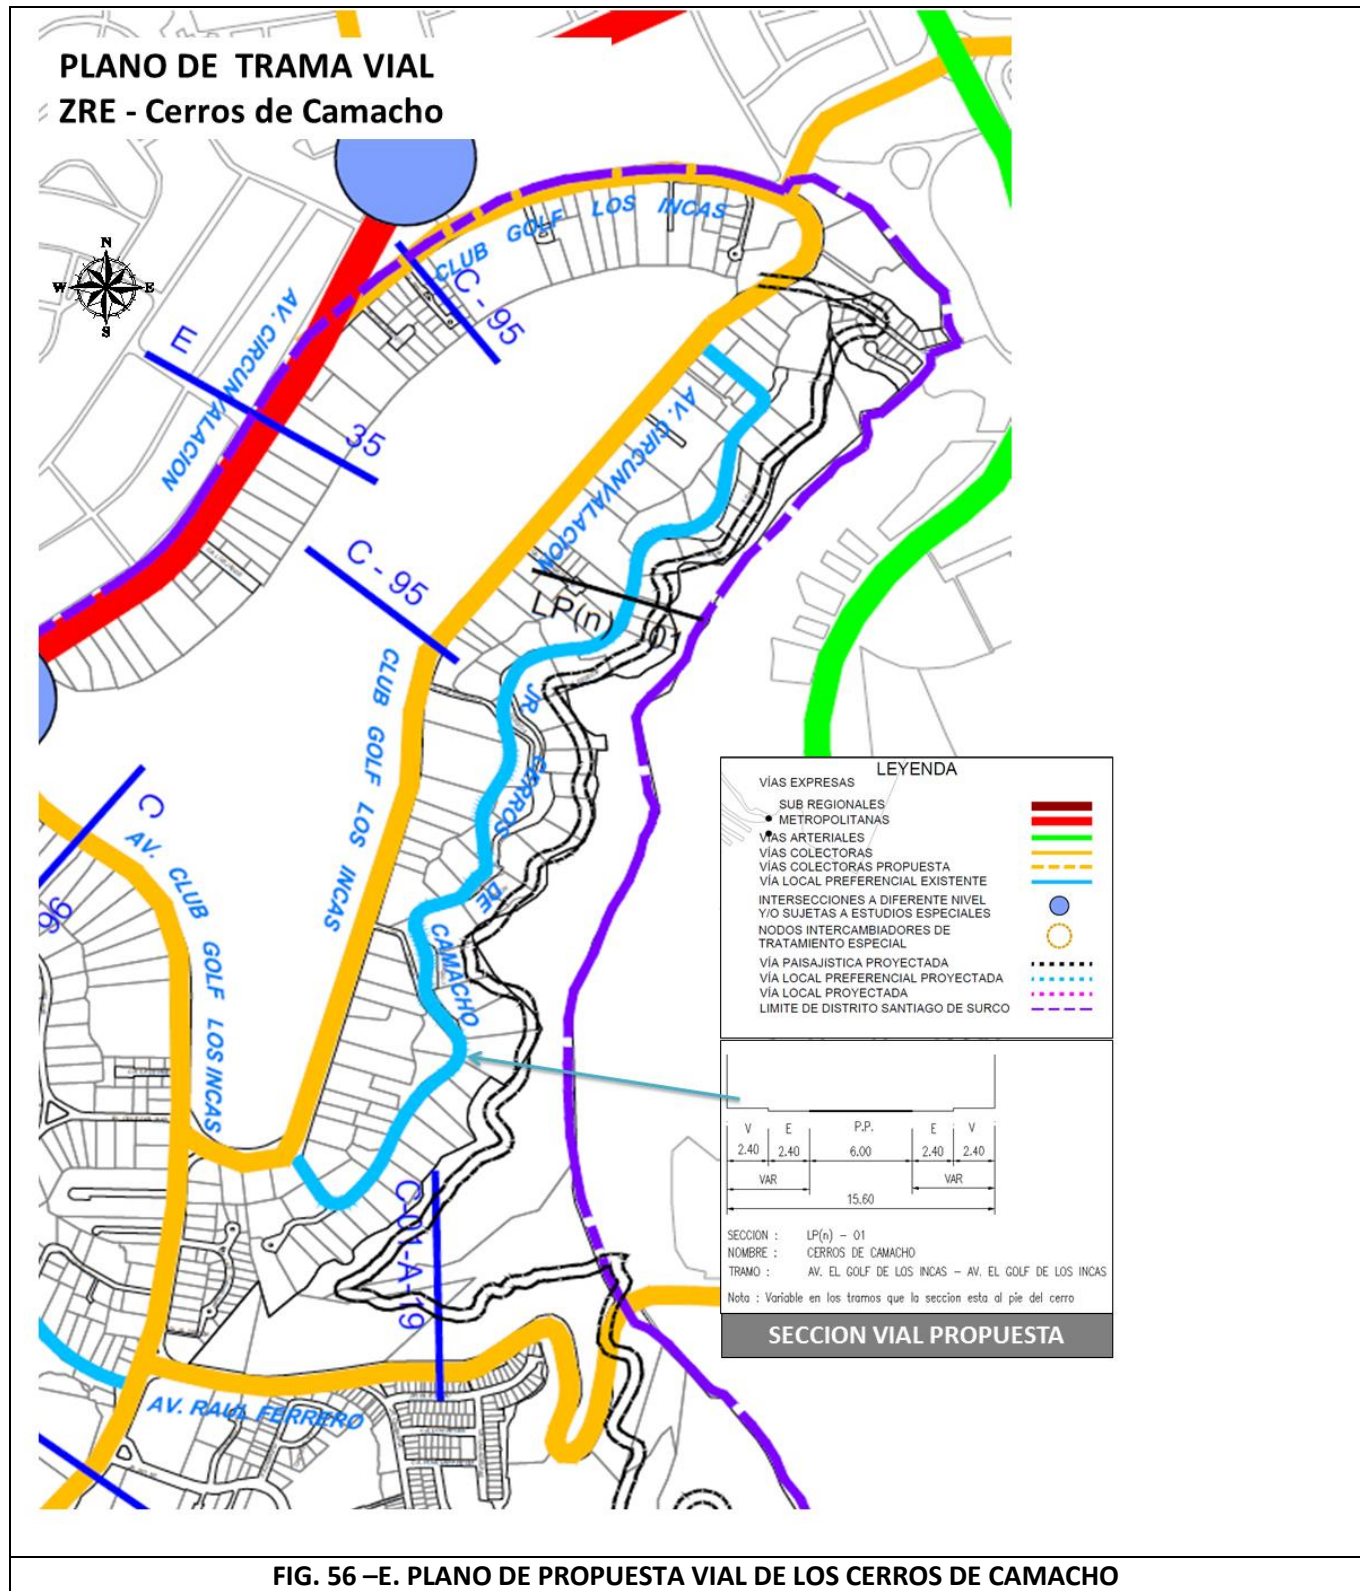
E. PLANO DE PROPUESTA VIAL DE LOS CERROS DE CAMACHO
